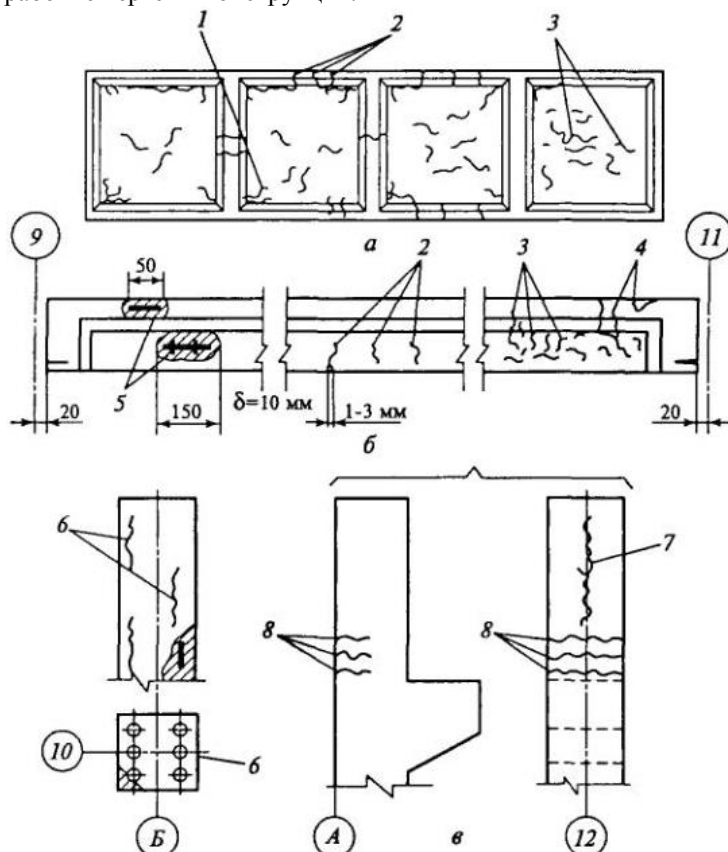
Характер образования трещин и повреждений в элементах железобетонных конструкций от огневого воздействия: а – в ребристых плитах покрытий и перекрытий; б – в прогонах, балках, ригелях; в – колоннах, стойках, элементах ферм
